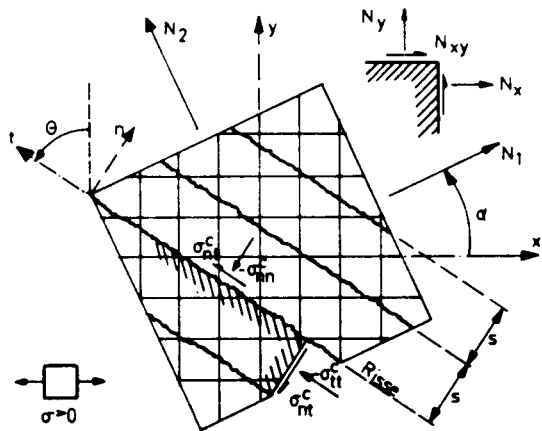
Gerissene Stahlbetonscheibe
